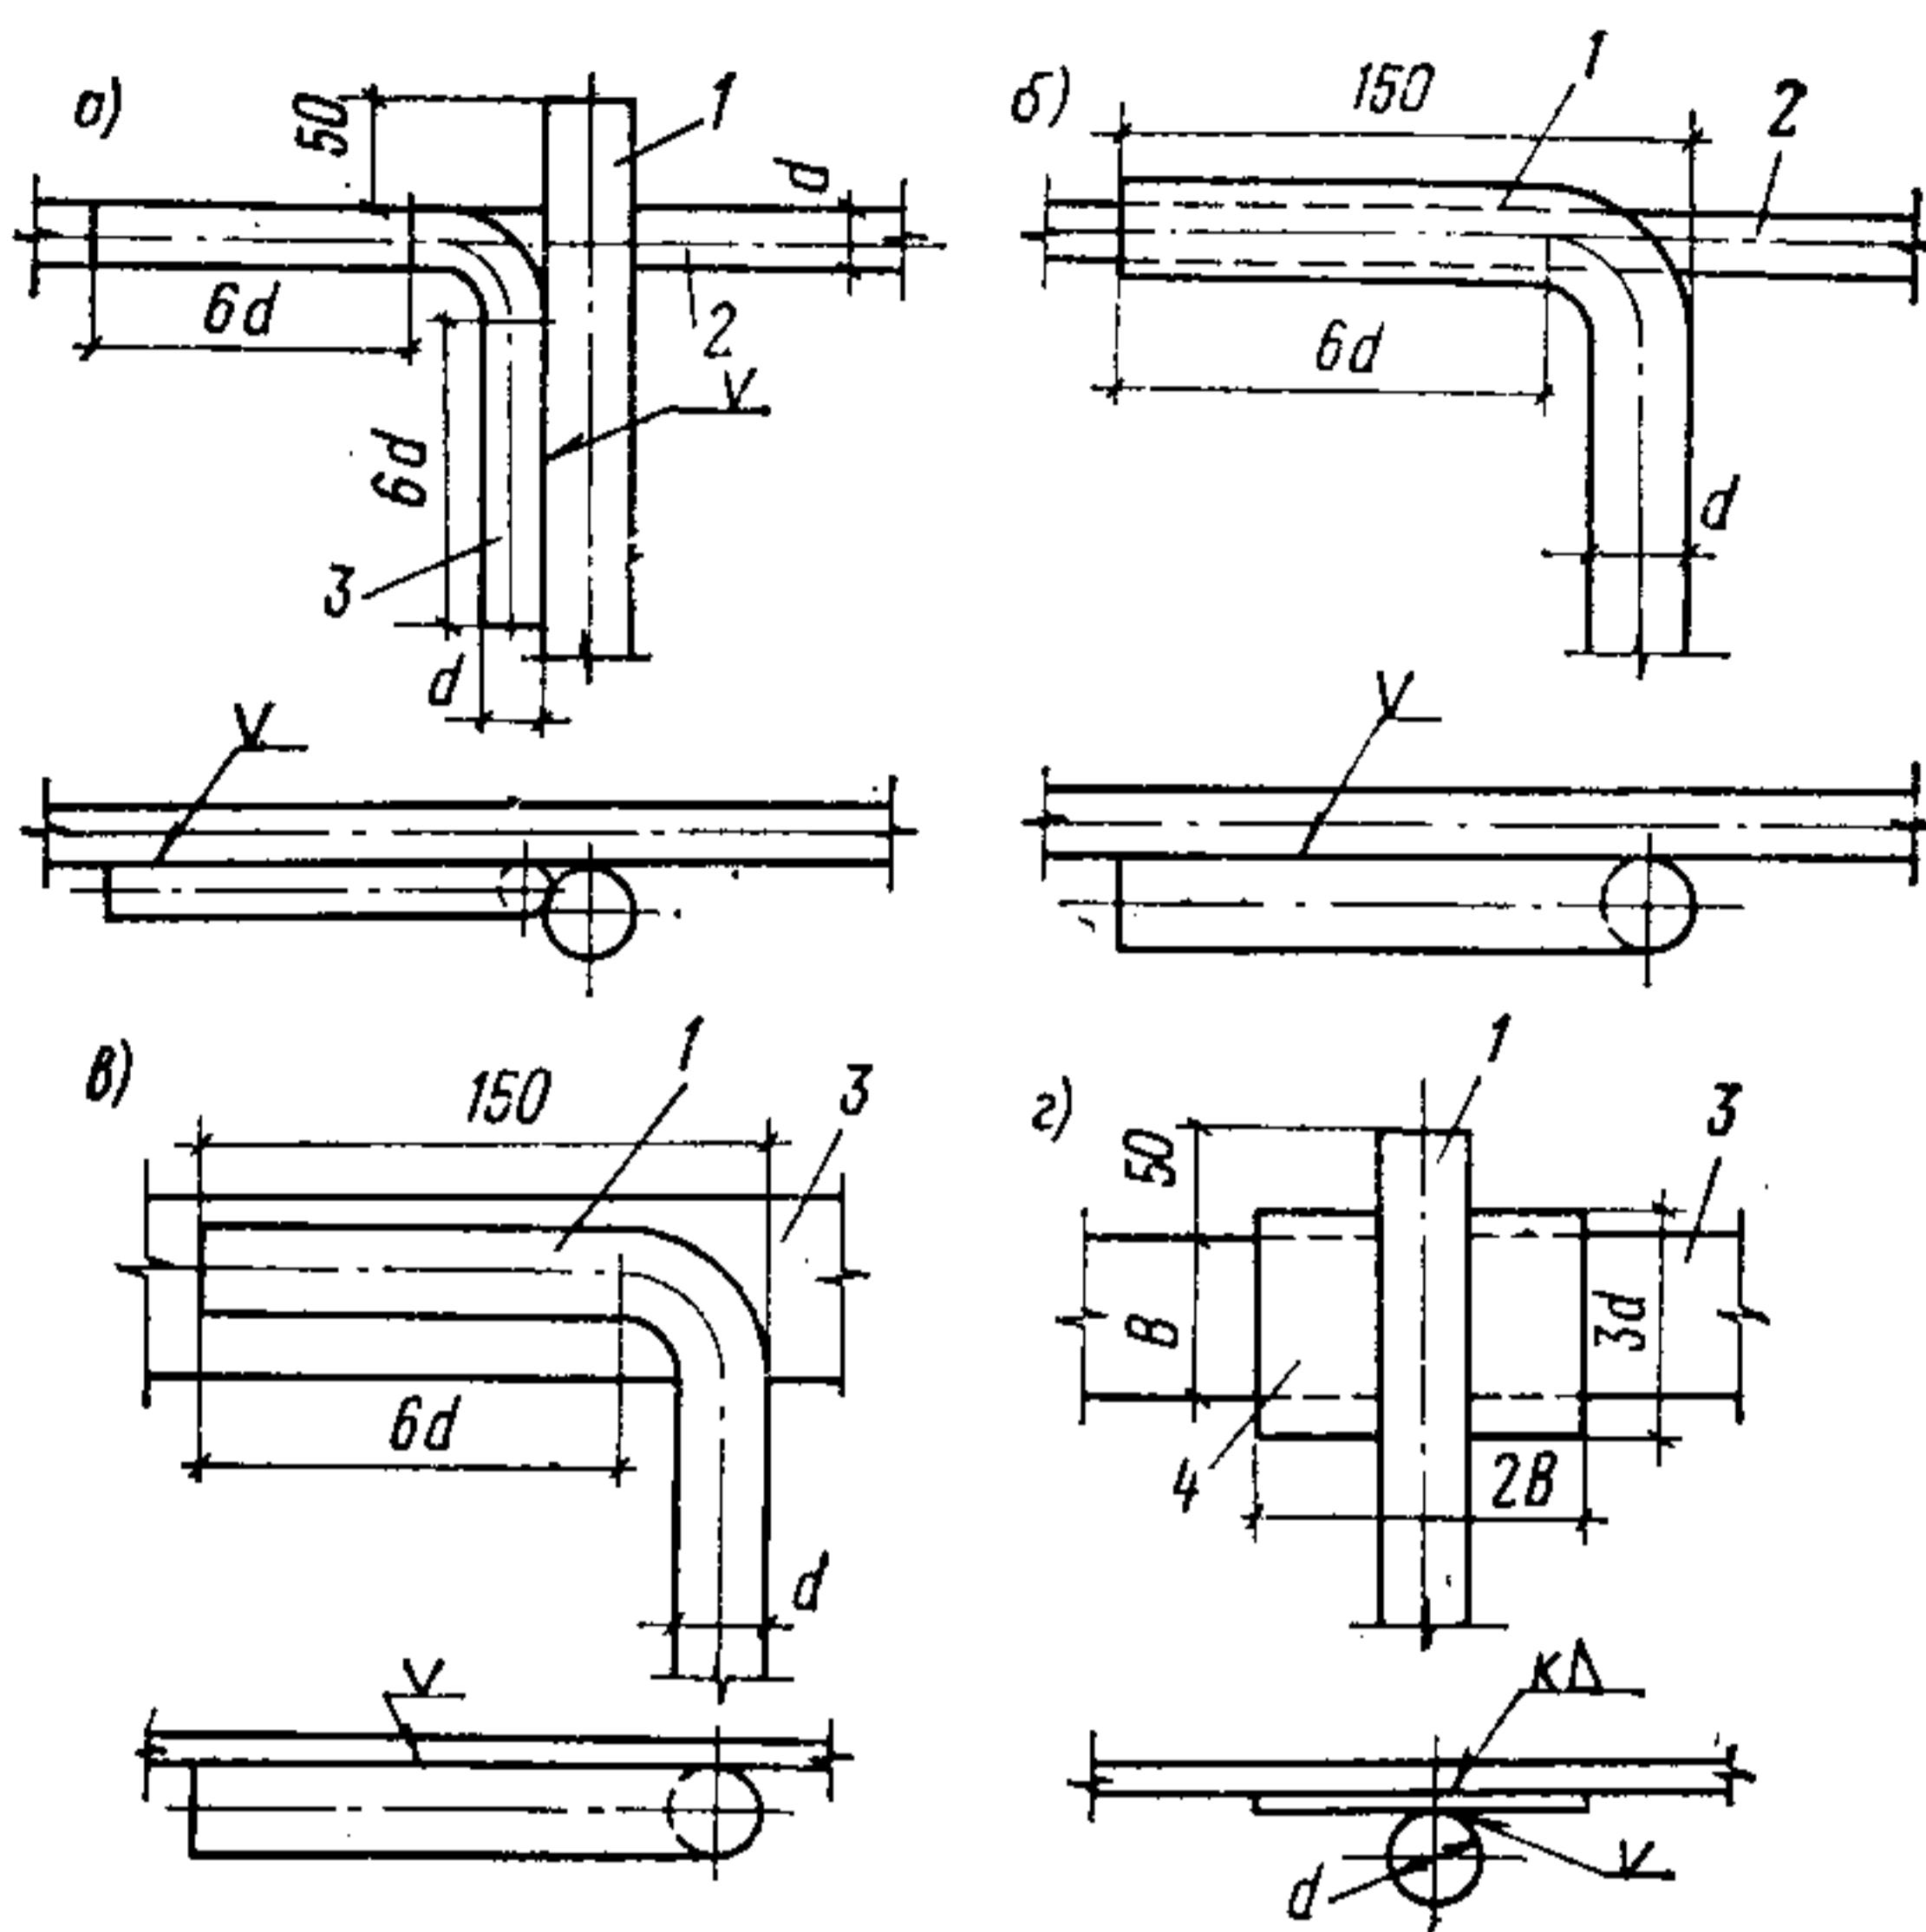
Соединения стержневых заземлителей с заземляющими проводниками (длина сварного шва $L \geq 6d$)
